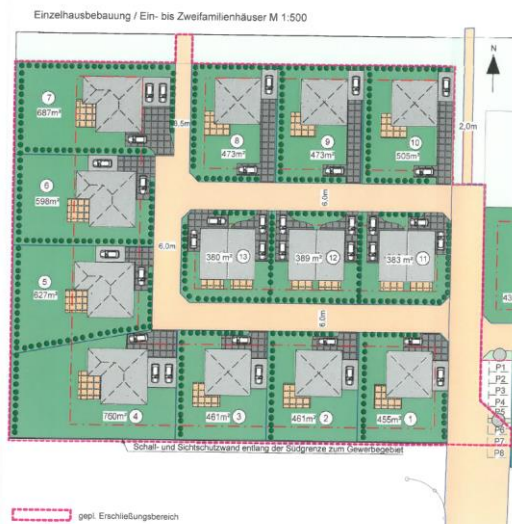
Bauentswurf „Hans-Joachim-Dankworth-Str., 1. Bauabschnitt“ (Kempf 2016)
